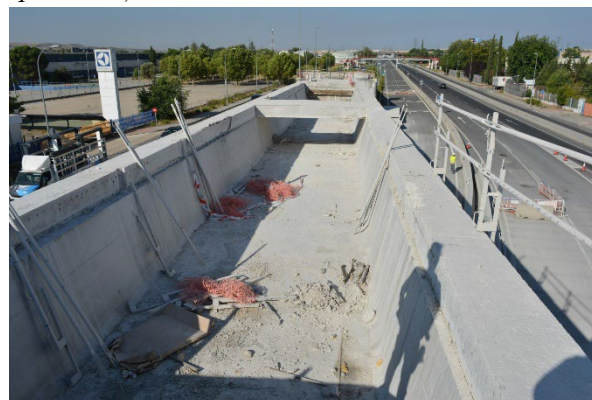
Desmontaje de losa entre almas con pieza central de arriostramiento
